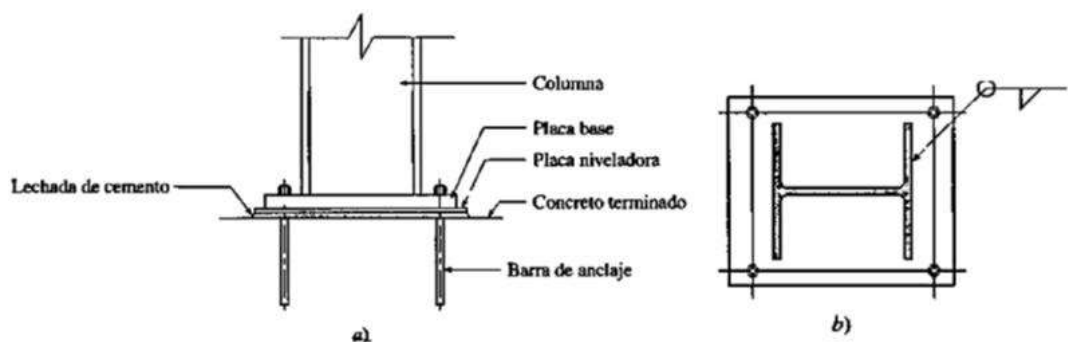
Detalle de placas base y pernos de anclaje para anclar columnas de acero a la cimentación
